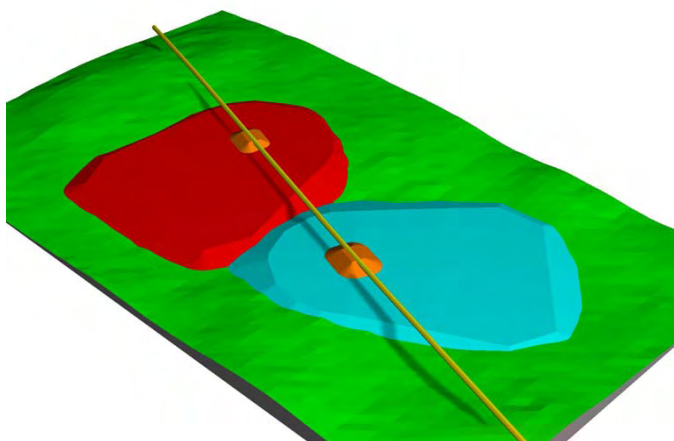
Компенсирующая засыпка (красная и синяя) для обеспечения дополнительной устойчивости под грунтовыми бермами (оранжевые)
